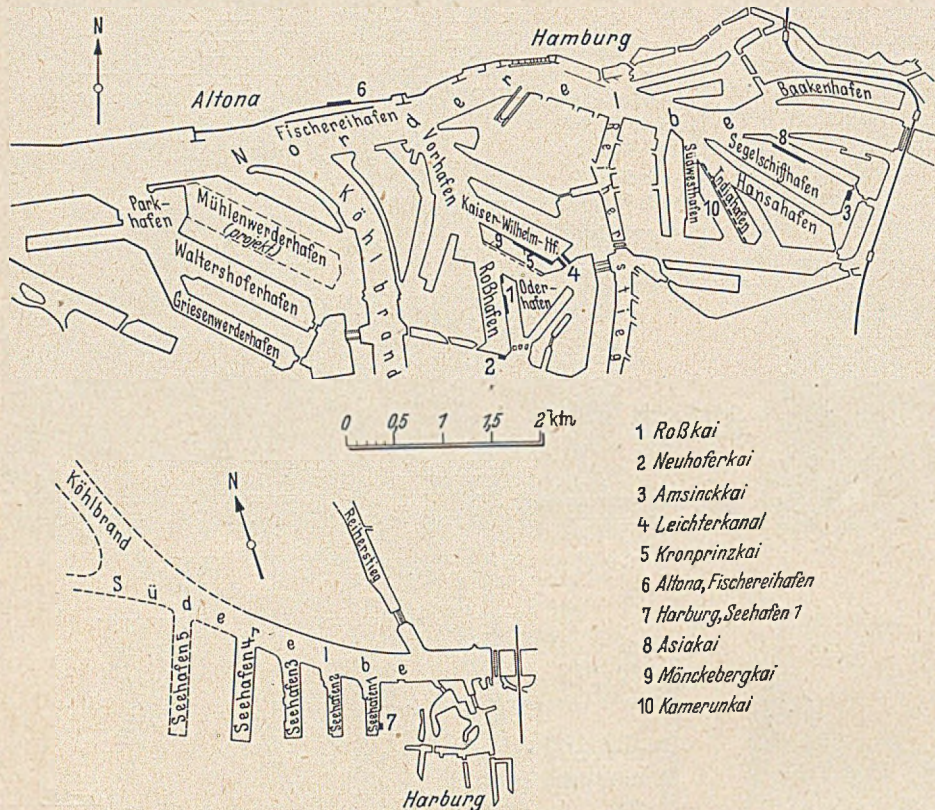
Lageplan der wiederhergestellten Kaimauern.
